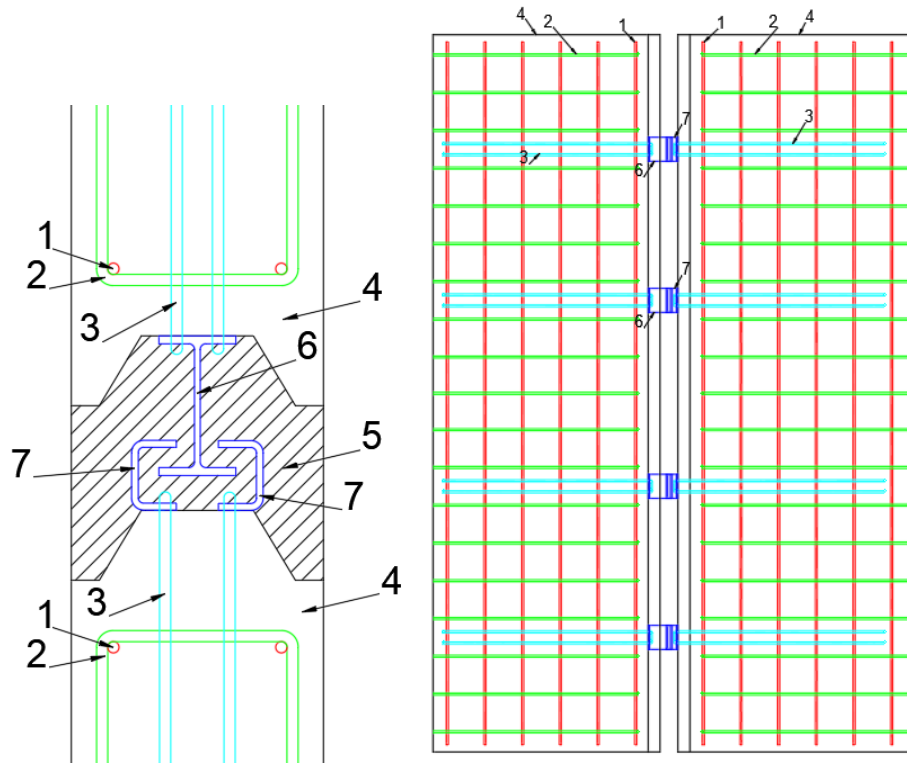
Разрабатываемое узловое соединение в плане. 1 – вертикальное армирование, 2 – горизонтальное армирование, 3 – анкера, 4 – тело панели, 5 – бетон омоноличивания, 6 – двутавровая монтажная деталь, 7 – комплект швеллеровых монтажных деталей.
